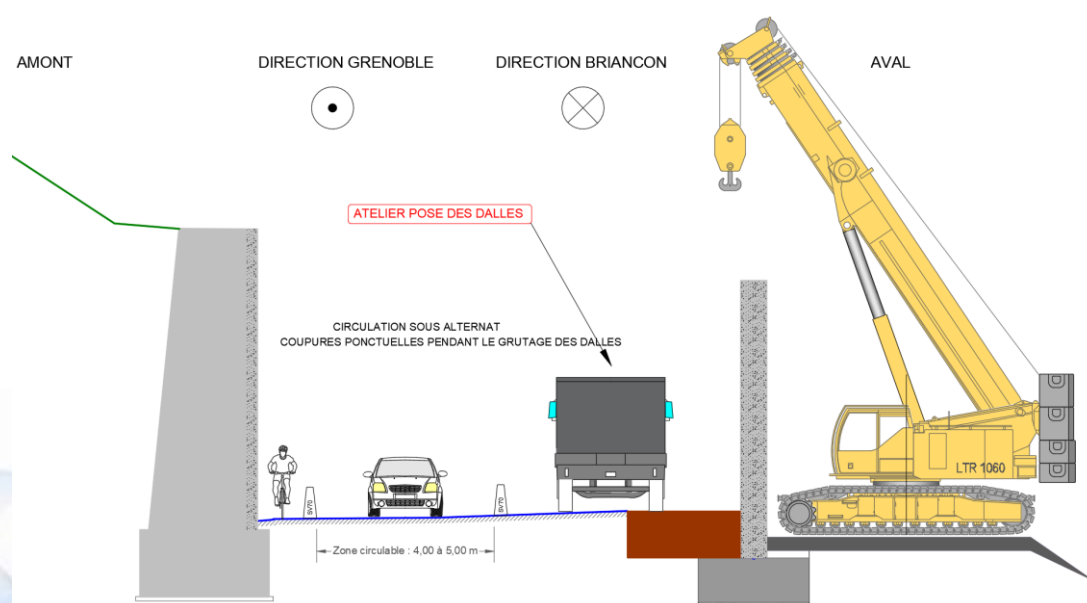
Configuration travaux lors de la pose des dalles de nuit
